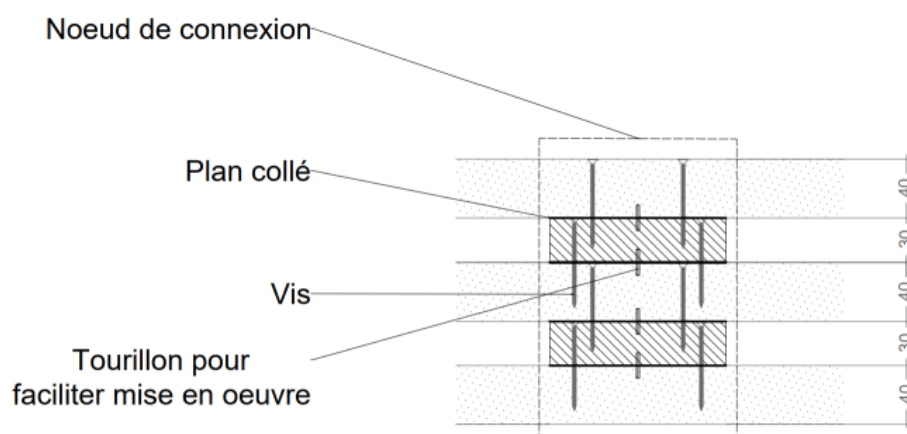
Schéma Connexion – Coupe – Exemple d'assemblage de plusieurs couches
